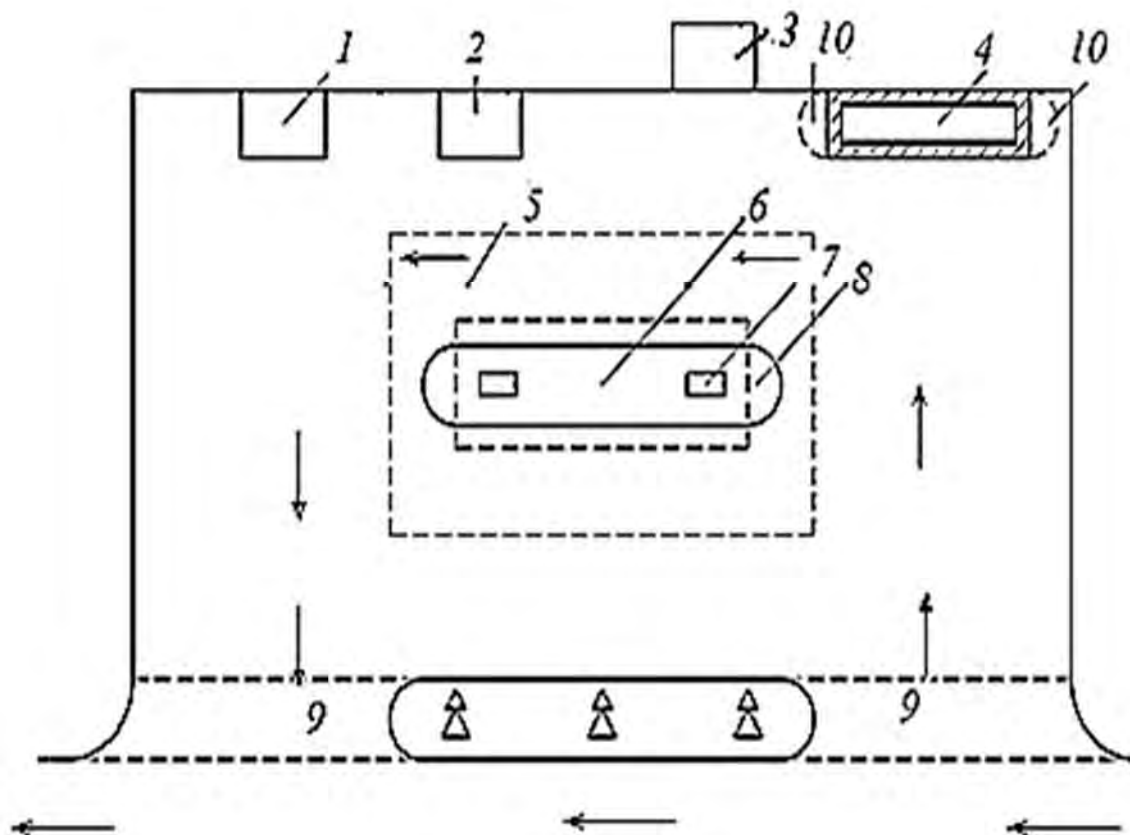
АЗС блочного типа: 1 – здание операторной; 2 – магазин; 3 – емкость для сбора крупных проливов топлива; 4 – площадка для автоцистерны с отбортовкой; 5 – навес; 6 – подземный резервуар; 7 – топливораздаточные колонки; 8 – заправочный островок; 9 – повышенный участок дороги; 10 – пологие борта площадки (пандусы)
